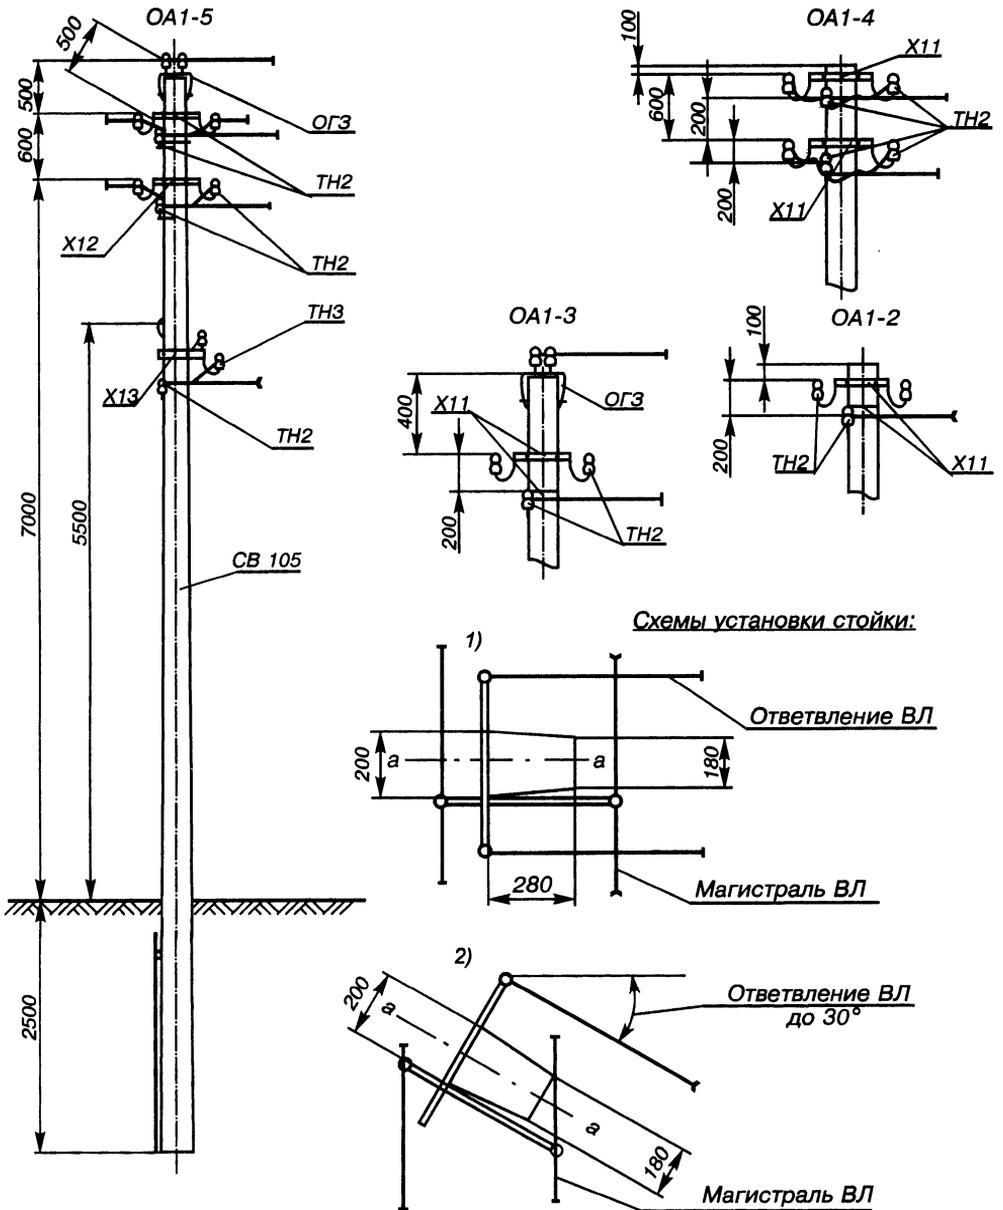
Линейная арматура для ответвительных анкерных опор
